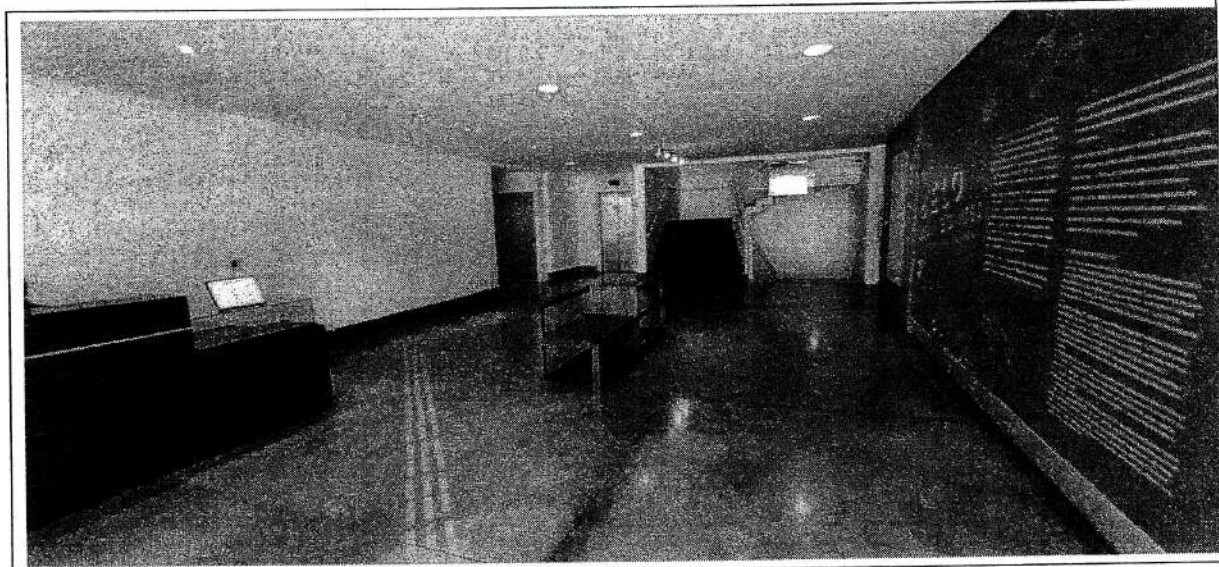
1º pavimento – balcão recepção, ao fundo circulação vertical. À direita sala de exposição
